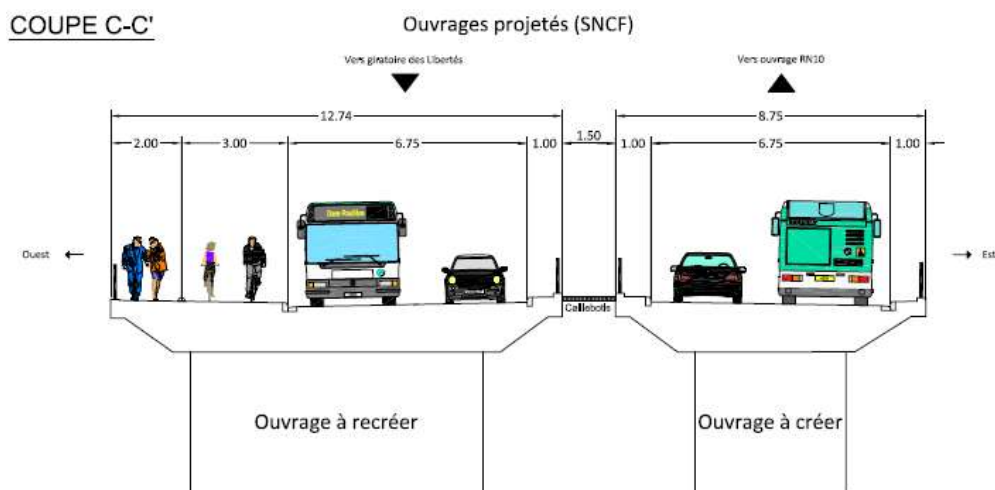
Profil en travers de l'option de reconstruction en place et élargissement de l'ouvrage SNCF
